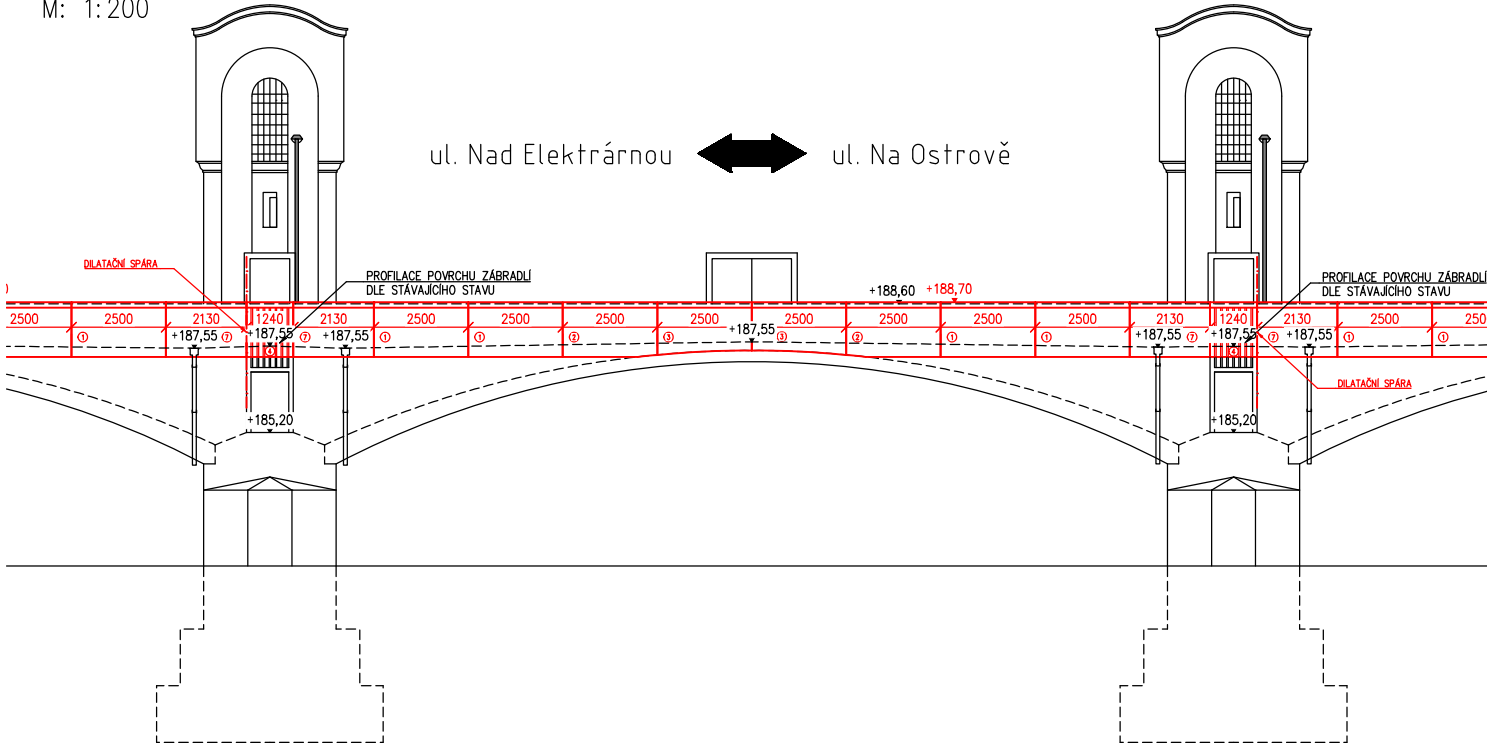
DETAIL PROFILACE PVRCHU ZÁBRADLÍ
